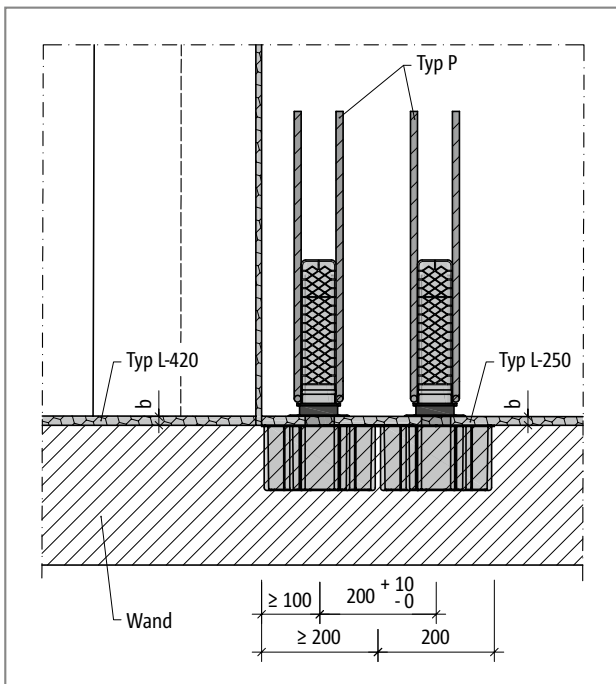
Schöck Tronsole® Typ P (paarweise Anordnung): Elementanordnung, Detail C, Fugenbreite $b = 15 \text{ mm}$ bei Ortbeton, bei Elementtreppentläufen ist die Notwendigkeit einer zusätzlichen Einbautoleranz durch den Planer zu prüfen
